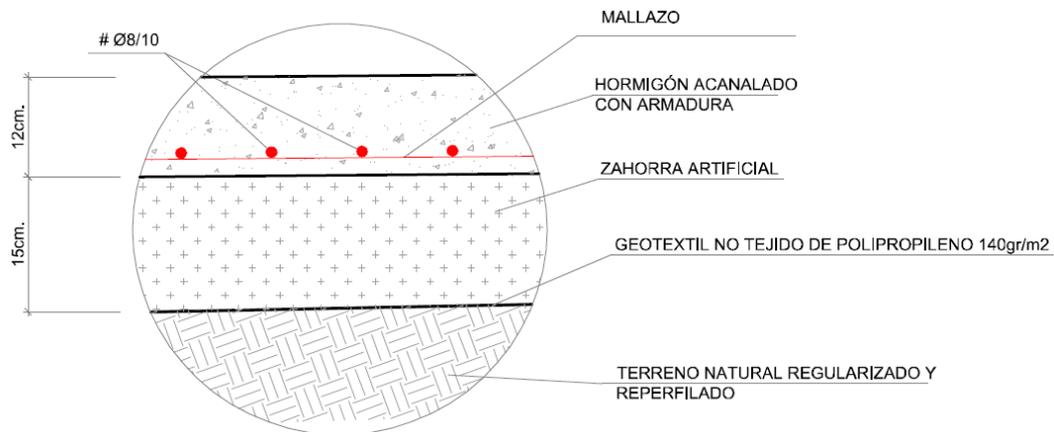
Sección tipo 1 y detalle. Fuente: Desarrollo del Plan de Contingencia de abastecimiento en caso de rotura del Canal Bajo. caminos de acceso a las casetas 7 y 8.
